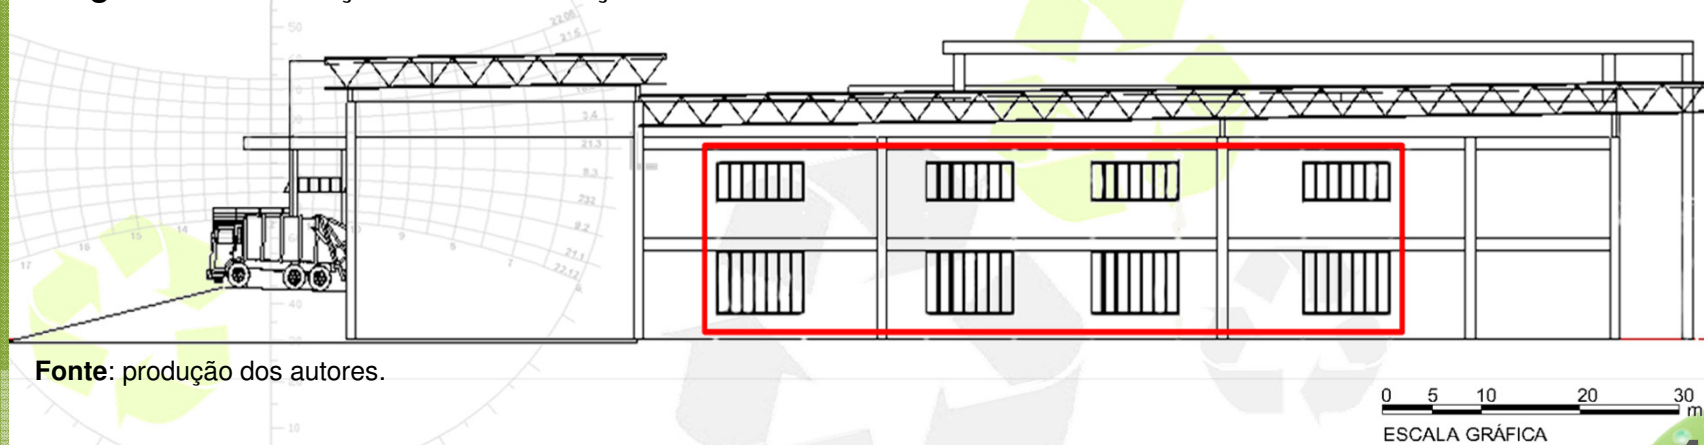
Elevação com identificação das aberturas da fachada norte
